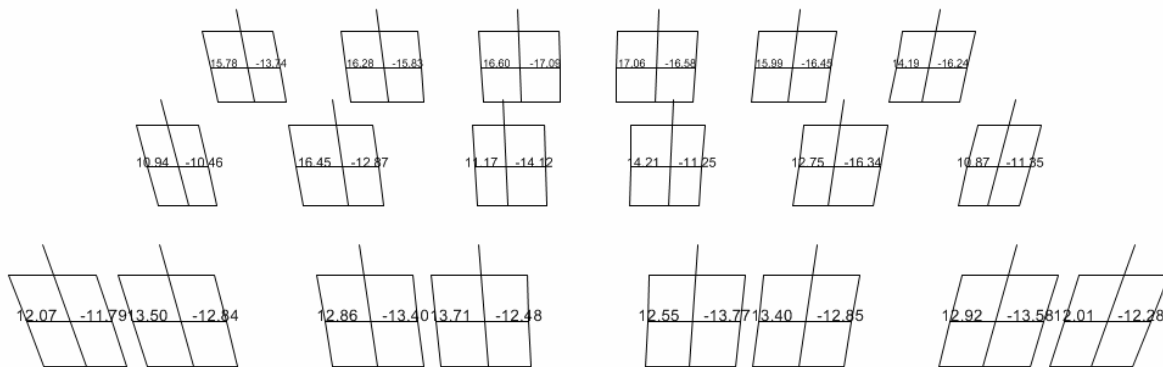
Se muestran los cortantes en la planta baja débil.
